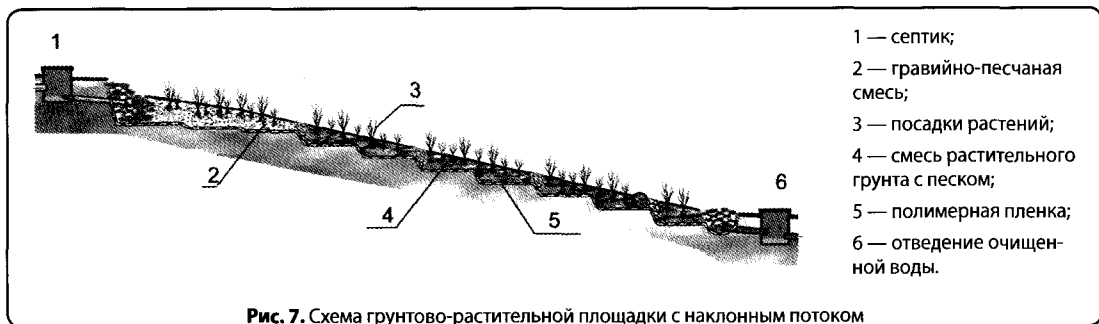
Схема грунтово-растительной площадки с наклонным потоком
